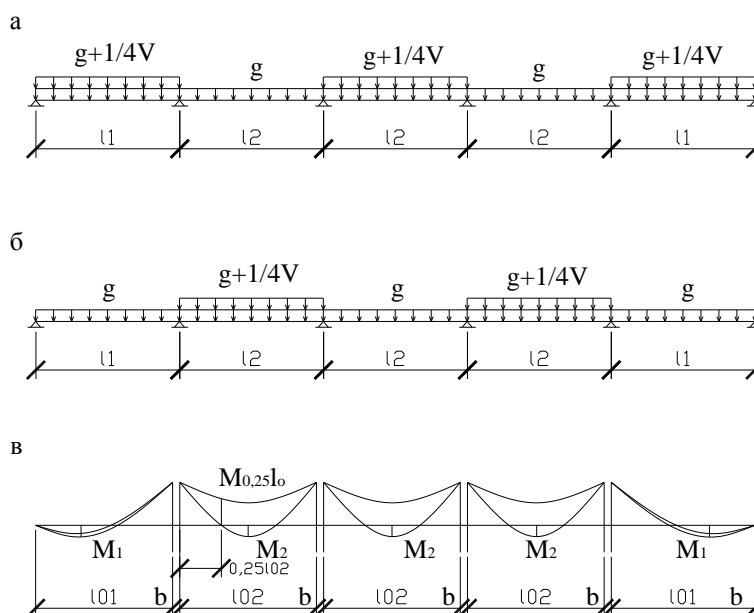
К расчету второстепенной балки ребристого монолитного перекрытия: а,б - схемы затруднения; в - огибающая эпюра моментов; b - ширина главкой балки; l_{02} расчетный пролет второстепенной балки
